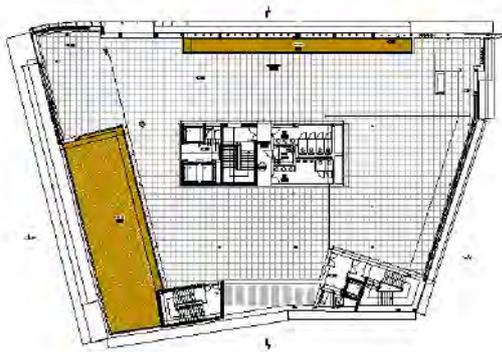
“Edifício Conde Barão” Projeto –Planta do piso 7 (Fonte: Gesturbe, proc. 782/EDI/2016)
